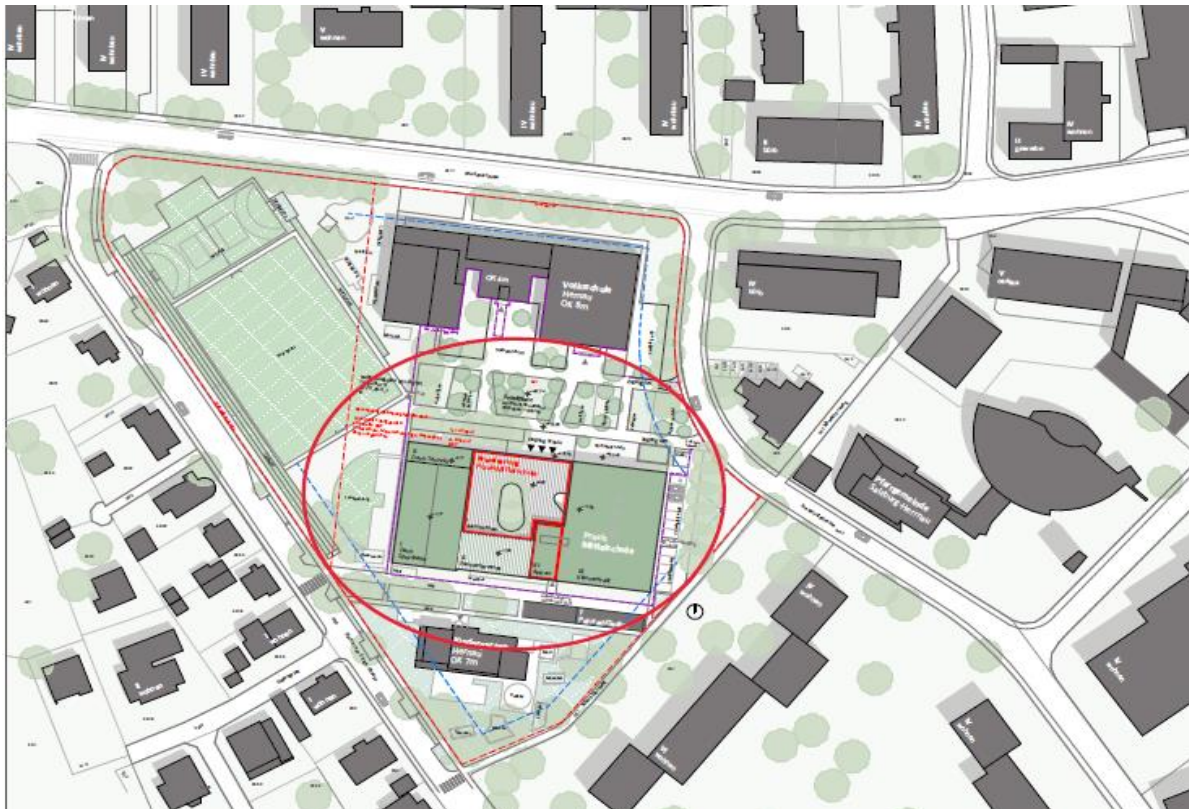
Lageplan (Quelle: planendes Architekturbüro) mit Markierung des Projekts
